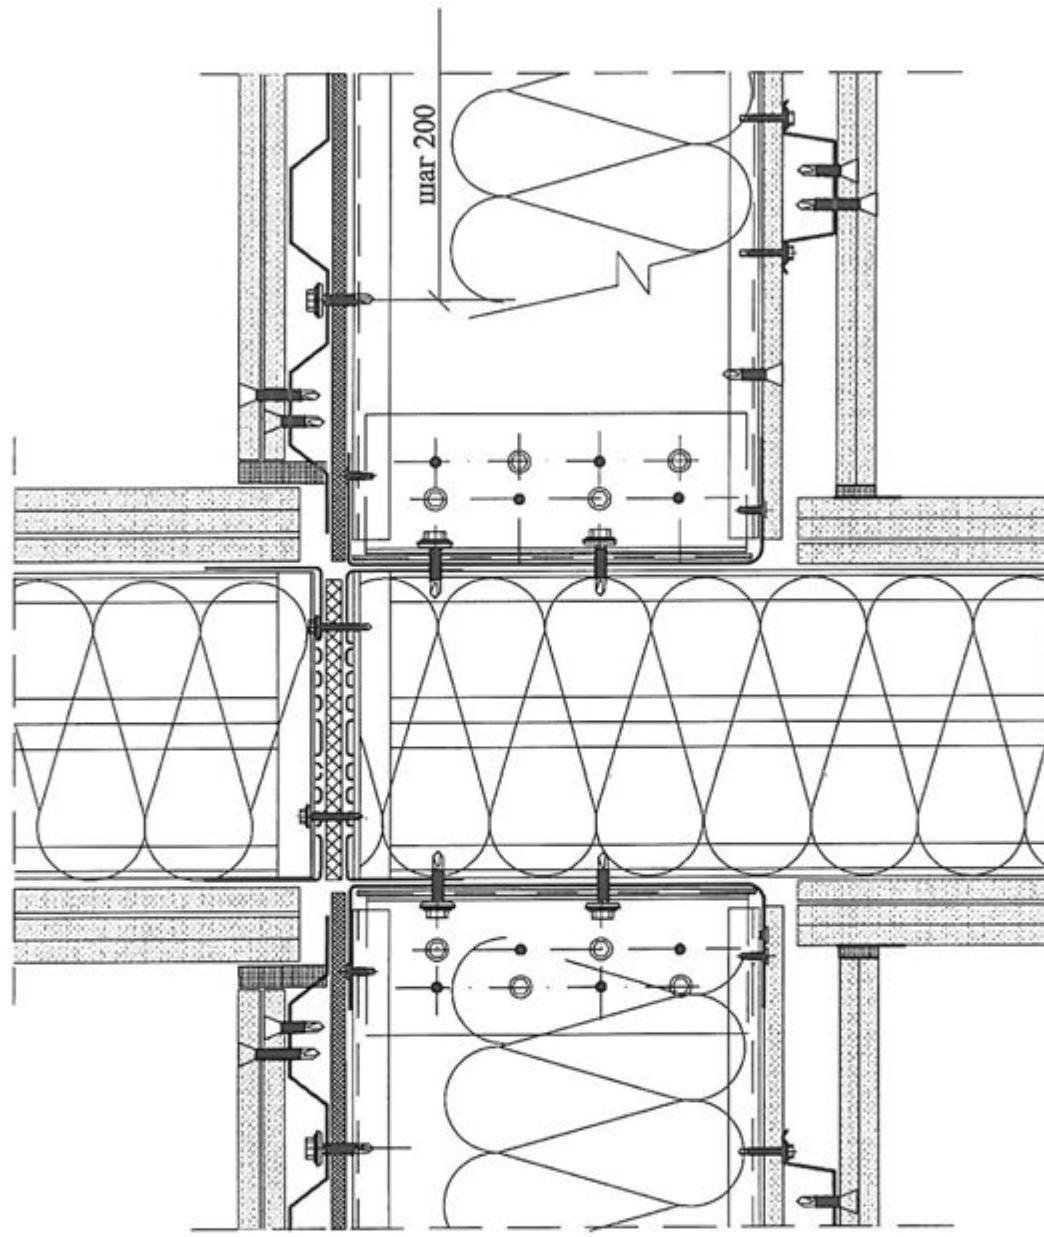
Узел крепления и примыкания конструкций междуэтажных перекрытий к внутренней несущей стене.
